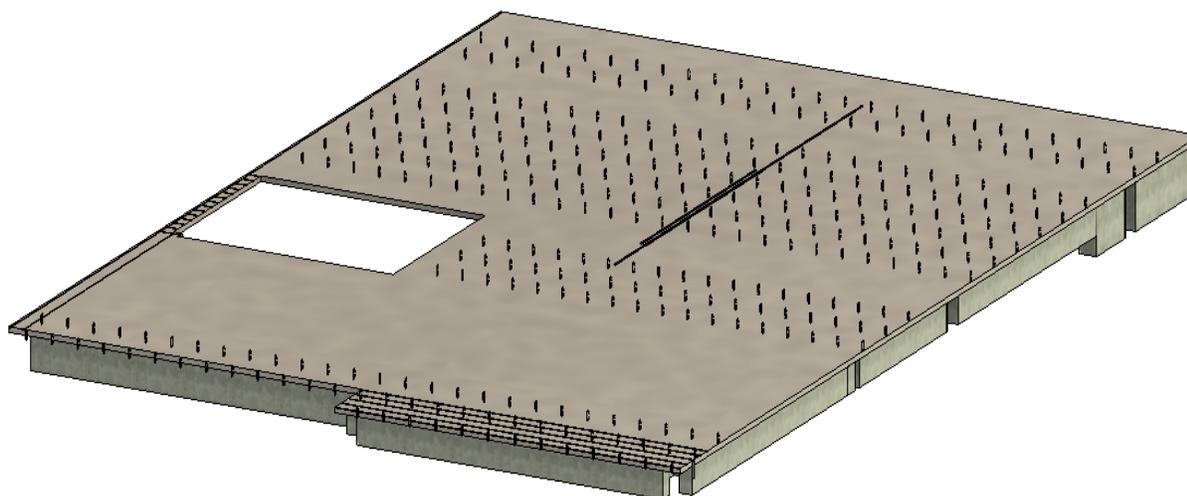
Vista realista superior de las vigas en Revit. (Autor)
